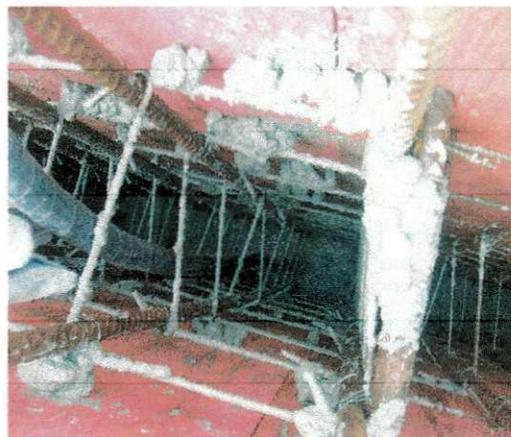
FORMA PRONTA PARA CONCRETAGEM
